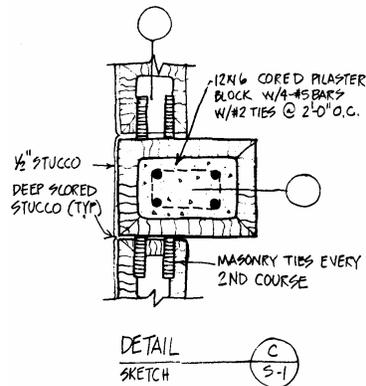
Desenho a mão-livre que ilustra o detalhe estruturas de uma pilastra com núcleo de aço.
